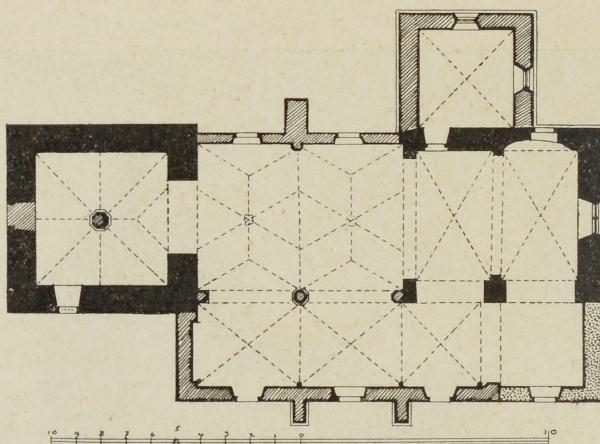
Mechernich. Grundriss der alten kathol. Pfarrkirche.
